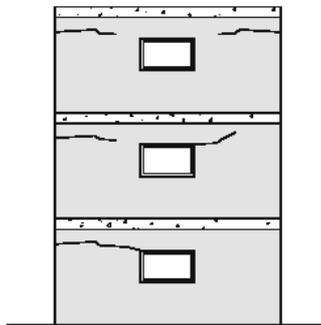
Fissuras em parede exterior, causadas pela retracção de lajes intermédias
